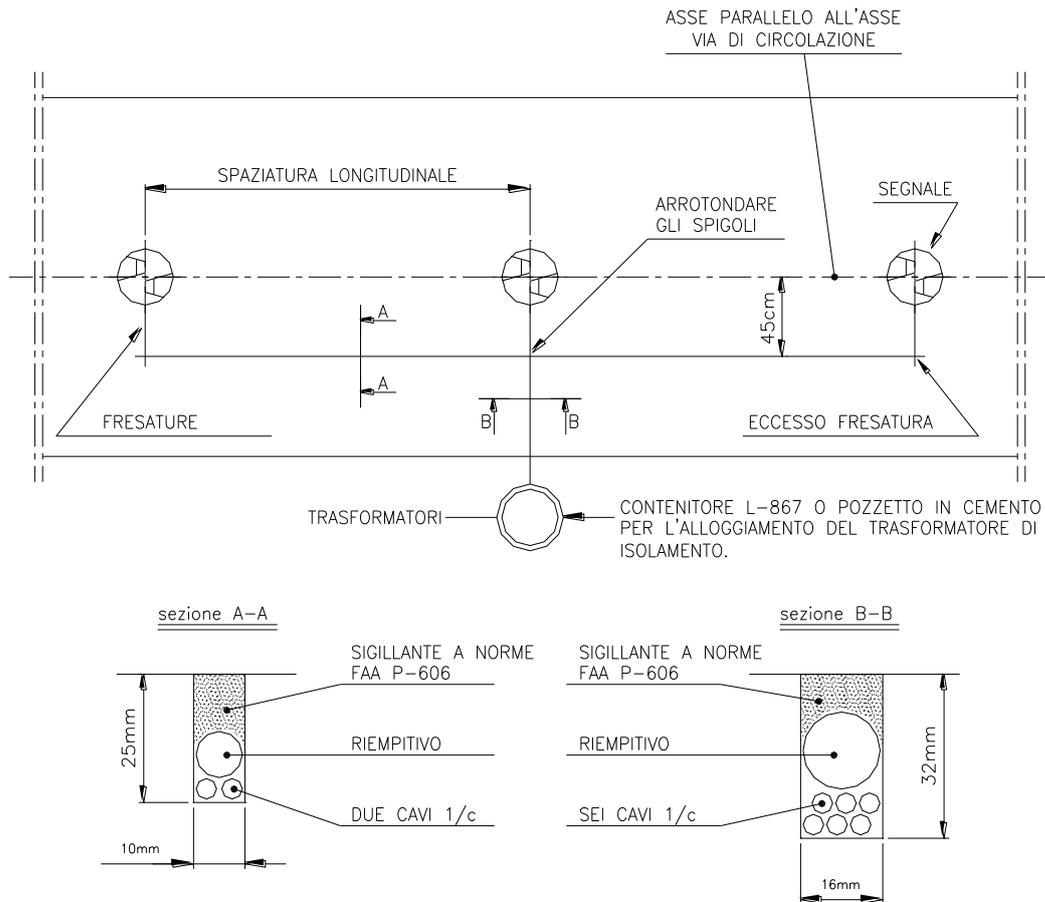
Asse Vie di Circolazione (OACI) Schema di Disposizione dei Segnali
